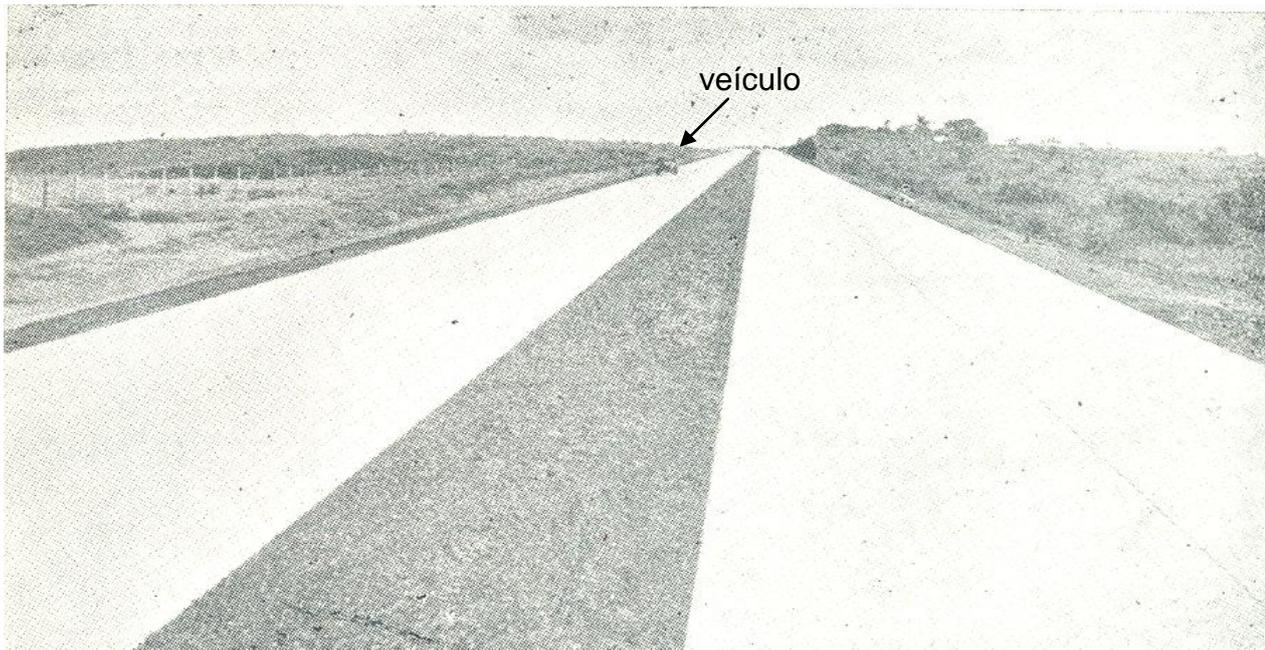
Via Anchieta. Fonte: Monteiro Filho (1961)
